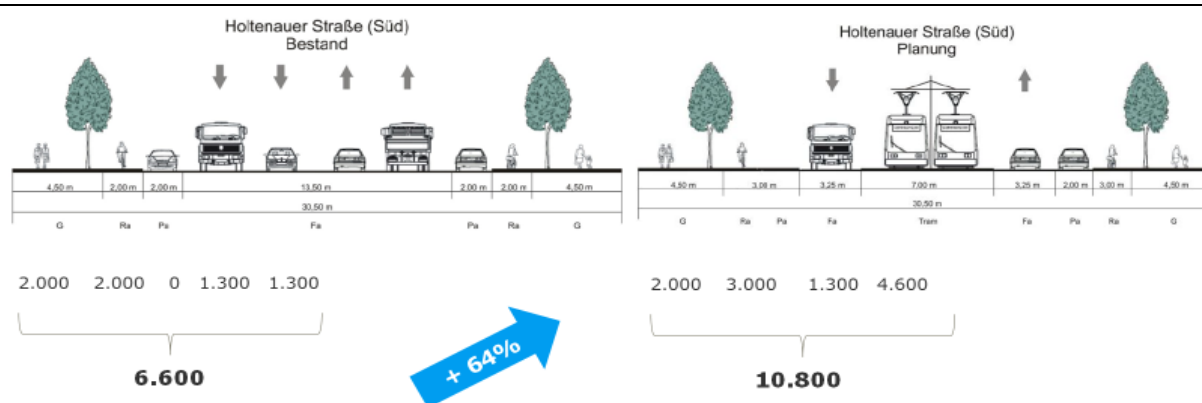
Exemplarische Kapazitätssteigerungen Holtenauer Straße mit HÖV-Trasse (Personen/Stunde)
